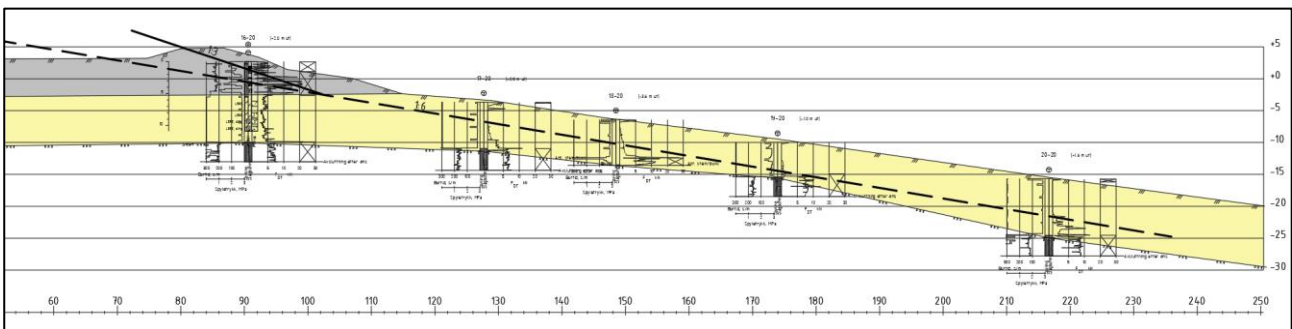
Profil 2-2 med tolket lagdeling. Stiplet linje viser 1:6 linjen, heltrukken linje viser 1:3 linjen.
